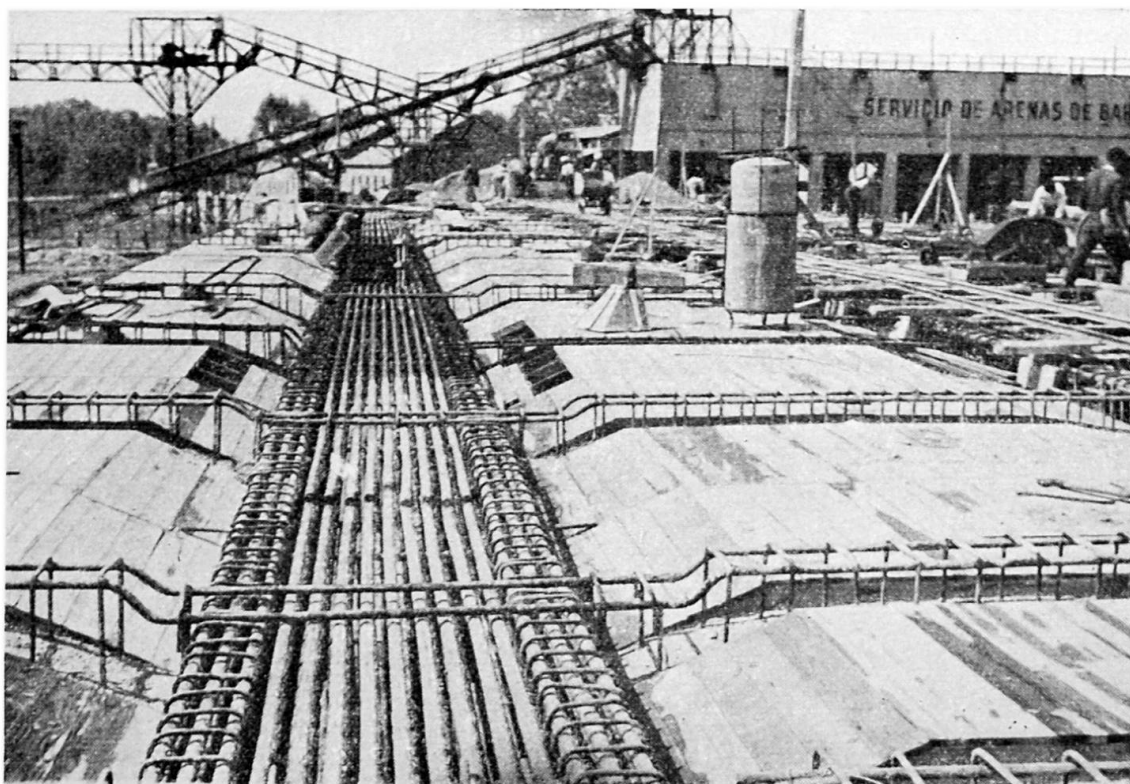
Ferrailage assemblé par soudure avant bétonnage.
